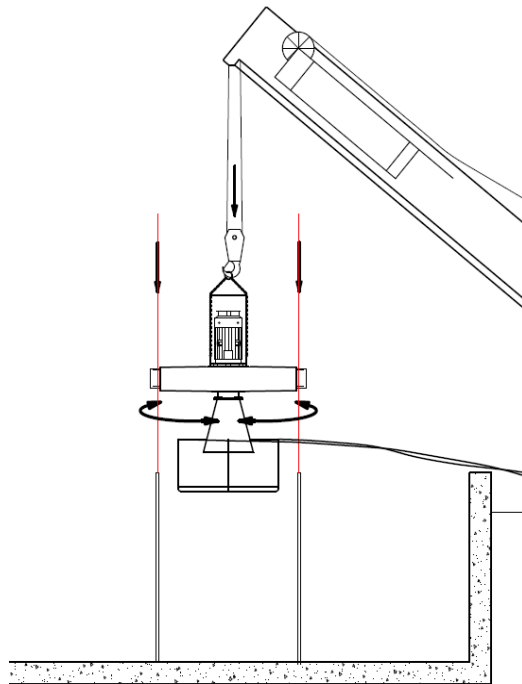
Installation des HSA mit vertikalen Führungsrohren
